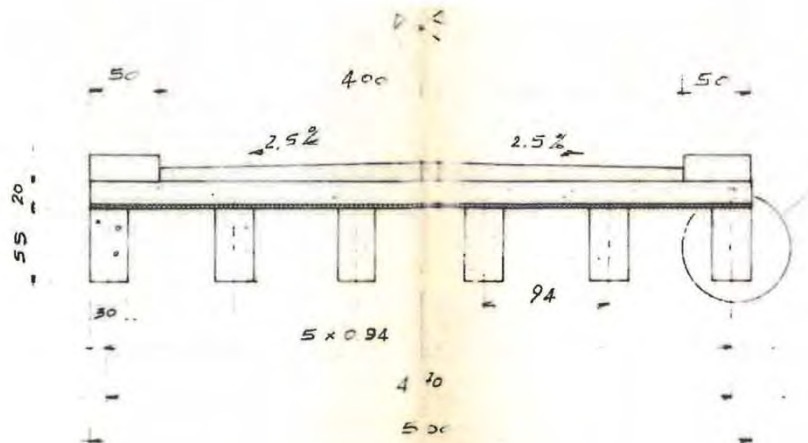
Coupe transversale de l'ouvrage (Extrait du plan d'archives)
